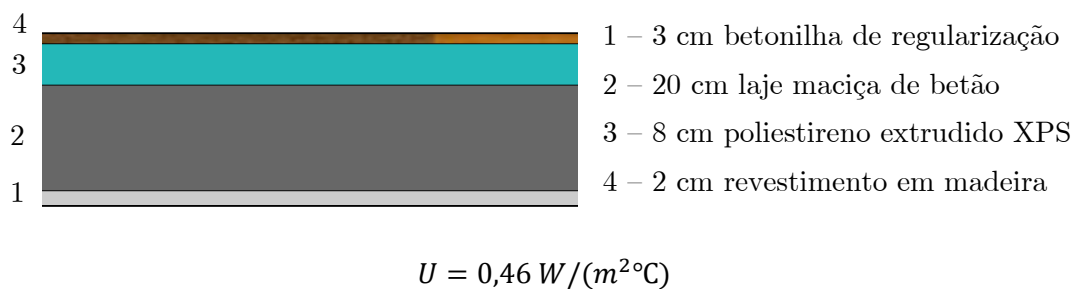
Exemplo de uma laje de pavimento em contato com U de referência
